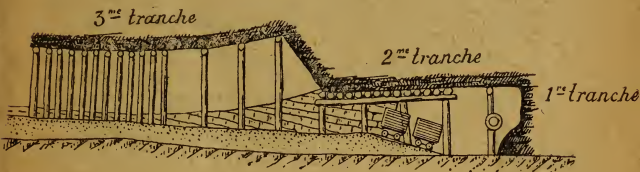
Abatage par tranches montantes (coupe par le plan incliné).
